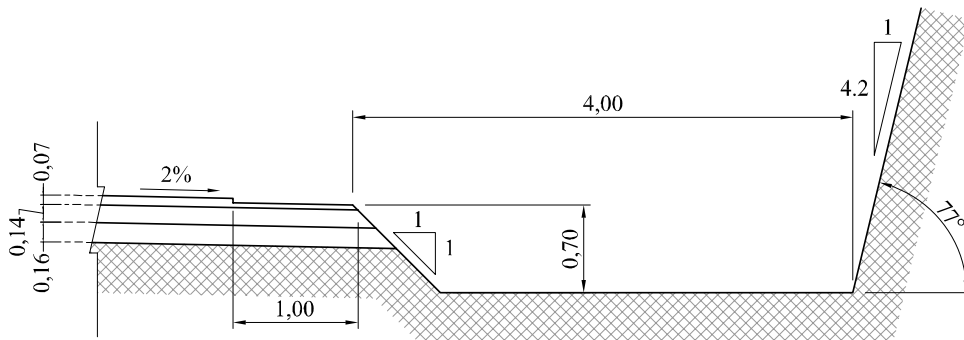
Detalhe da estrutura do pavimento e da área de retenção de blocos.
